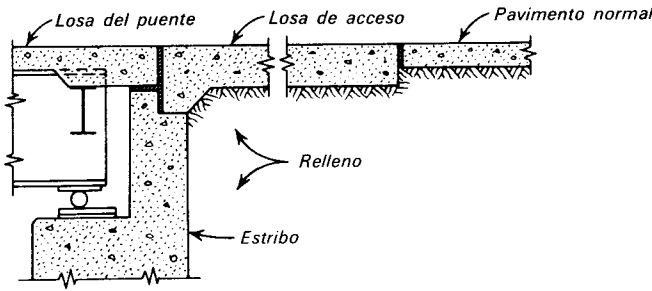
Losa de acceso para el estribo de un puente de carretera.
